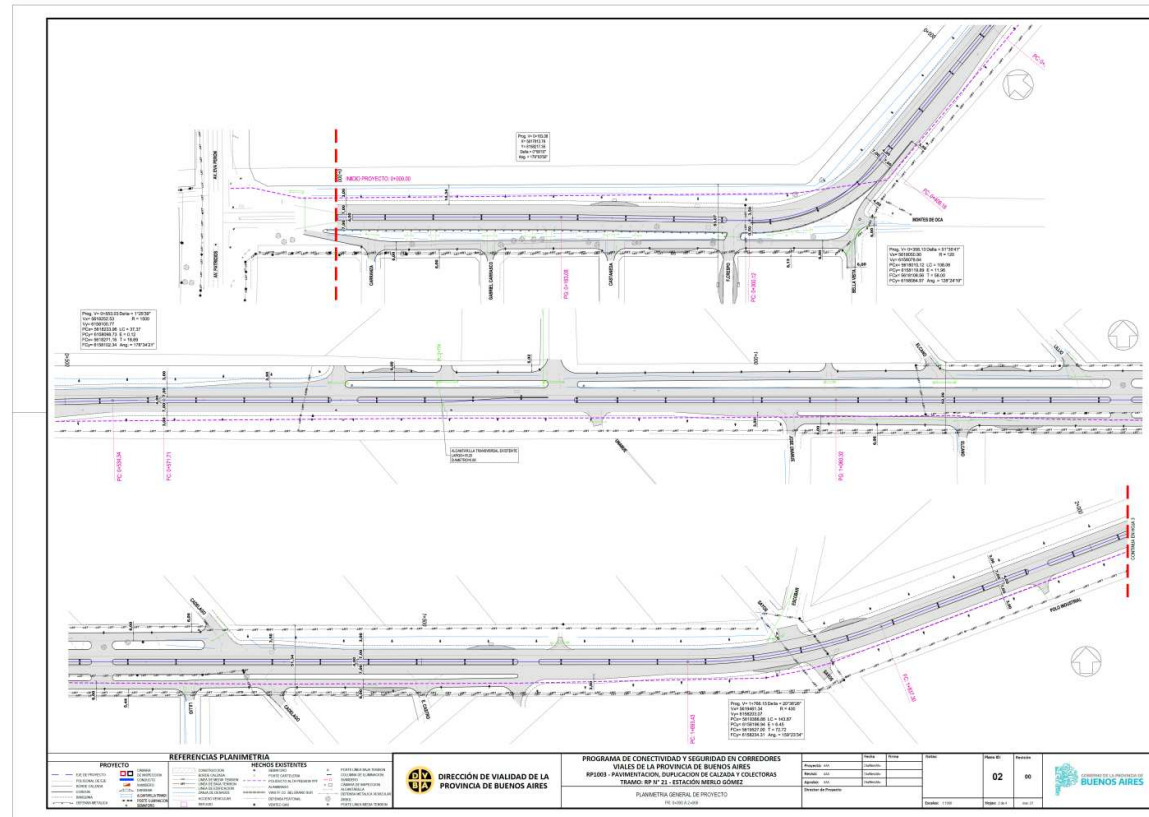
Planimetría general del proyecto, progresiva+0,00 a 2+000
